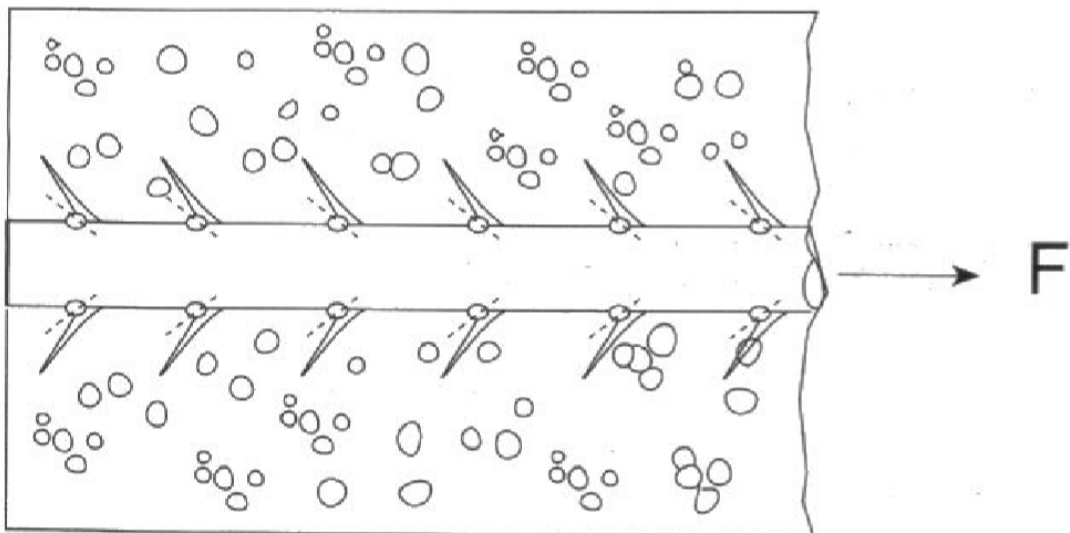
Propagación de las fisuras con un ángulo determinado respecto al eje de la barra.
